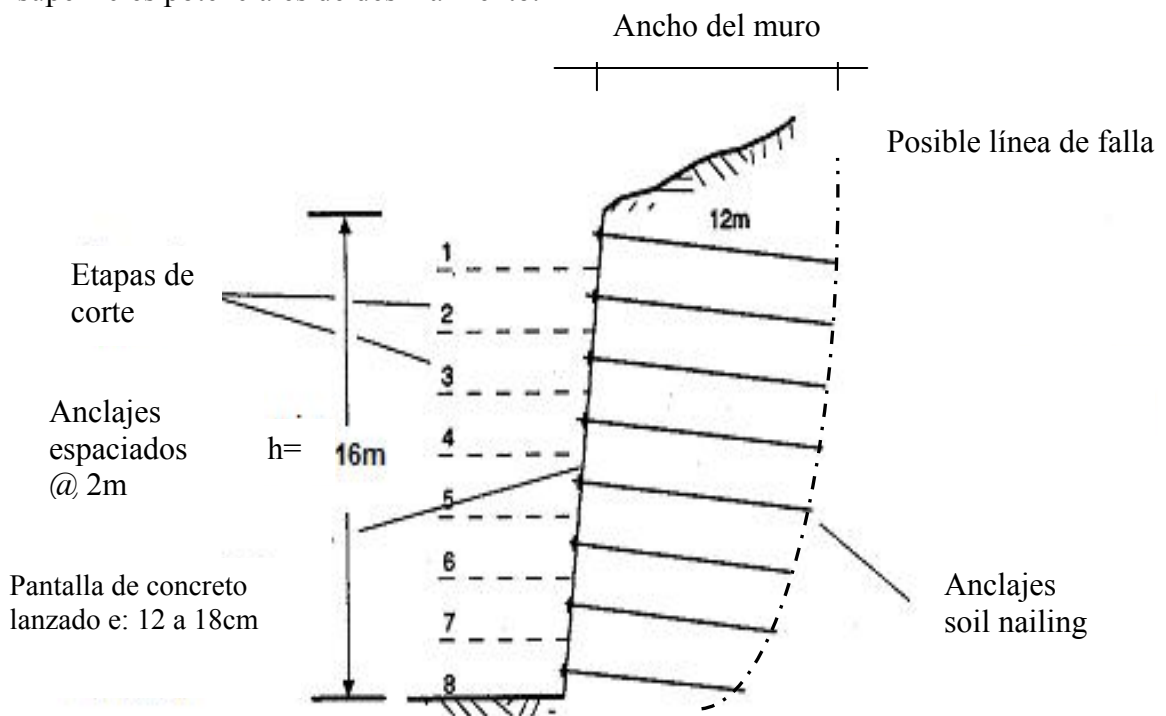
1 Sección vertical de un talud estabilizado con tecnología de tierra armada o soil nailing.
